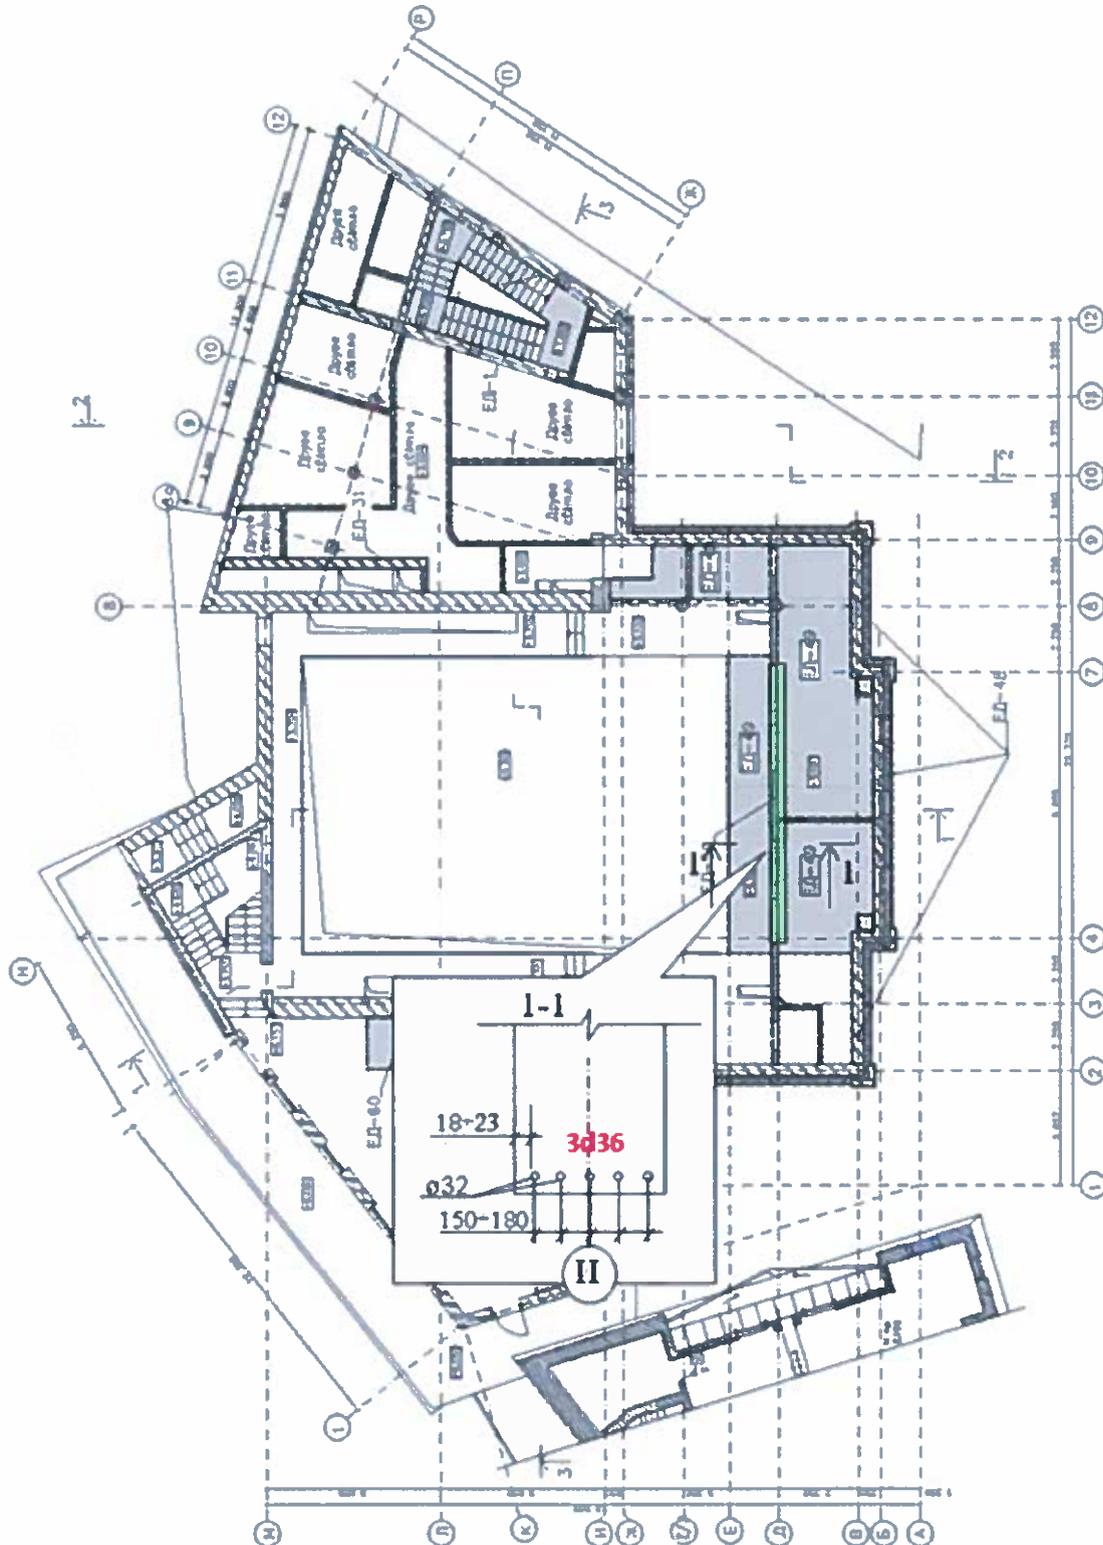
План будівлі на відмітці +5.400 з місцями визначення параметрів армування балки
